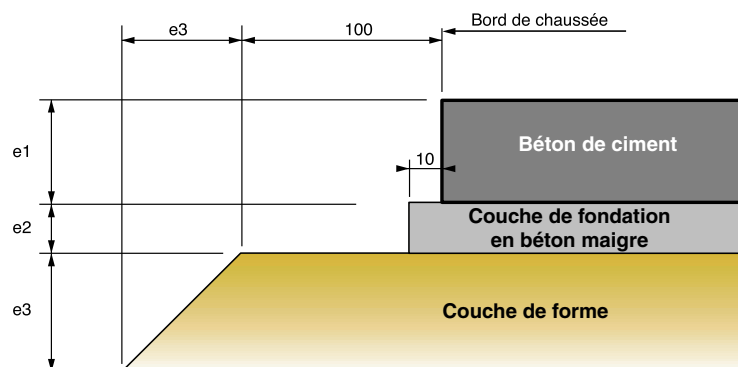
Surlargeurs des différentes couches de chaussées (béton maigre)
